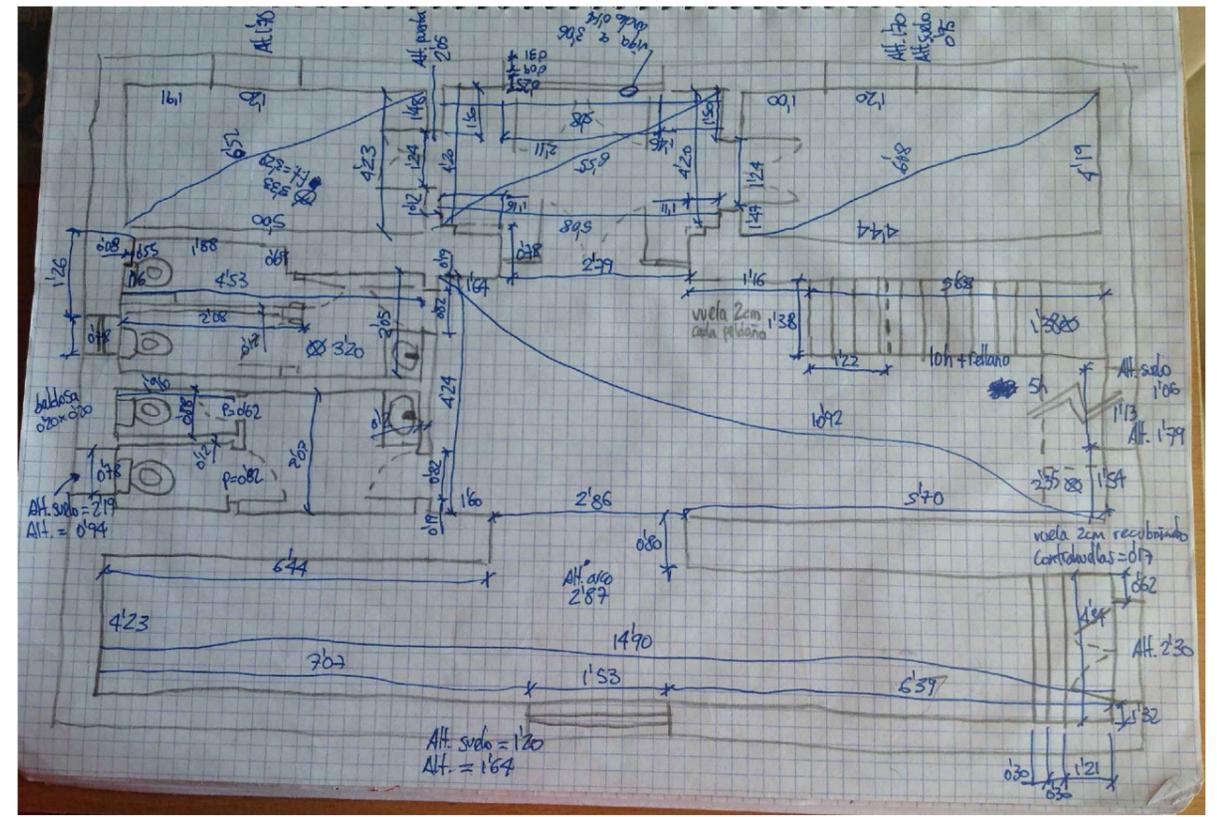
Planta baja. 2014. Fuente: elaboración propia.
